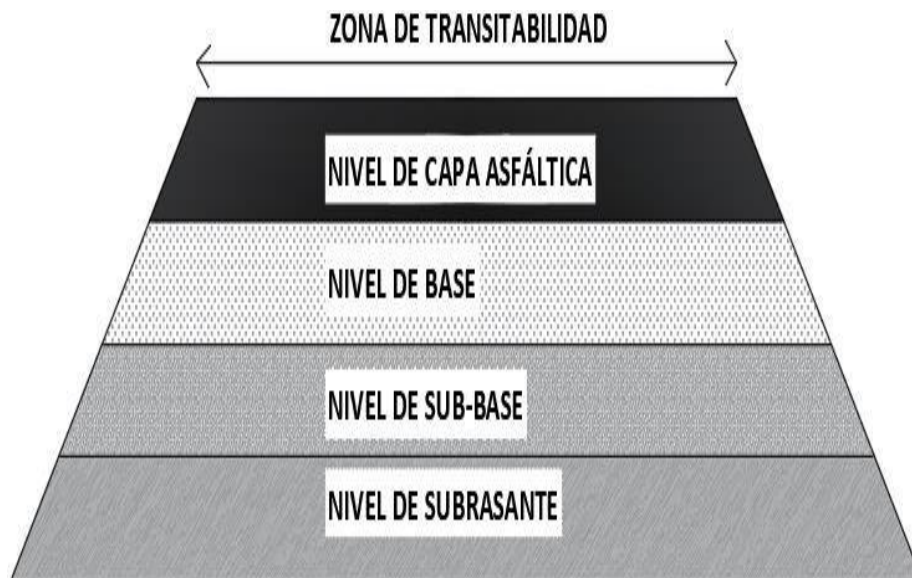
Niveles de capas estructurales de pavimentos asfálticos. Fuente propia.
